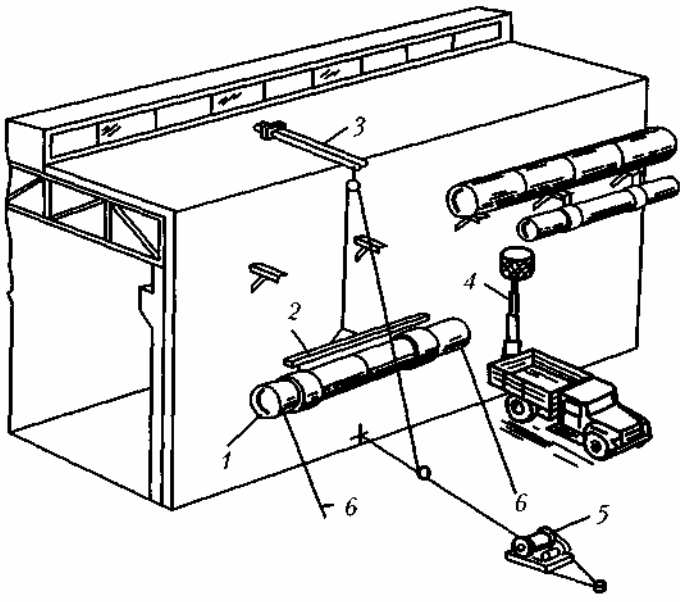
Монтаж горизонтальных воздухопроводов по наружным стенам: 1 — звено воздухопроводов; 2 — траверса; 3 — консоль с блоком; 4 — автовышка; 5 — электролебедка; 6 — оттяжка
